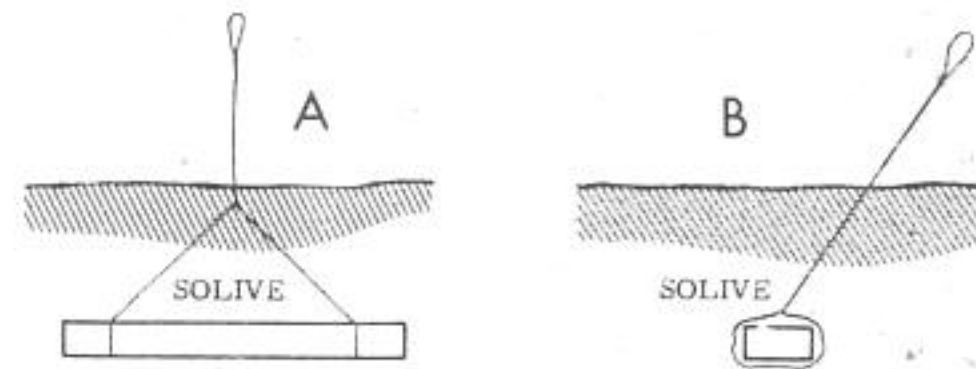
Fixation au sol des haubans, au moyen d'une petite planche en bois enterrée à une certaine profondeur. Le câble de fixation est relié à la planche par une bifurcation qui distribue l'effort sur toute la longueur. En A, vue frontale et en B, vue latérale. Remarquons l'inclinaison du câble de fixation.
